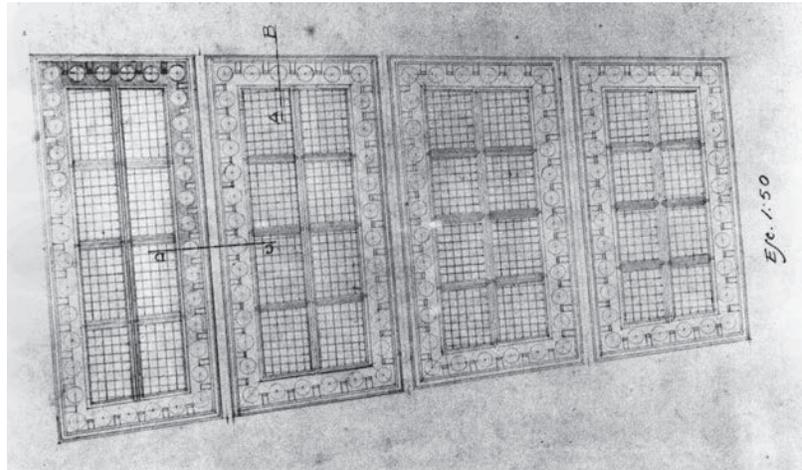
Estudio del patio norte: cubierta en *glass block*. Fuente: Planos originales encontrados en el edificio
